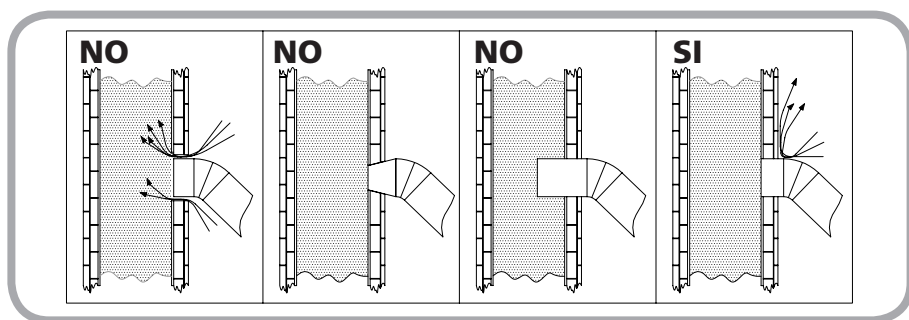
Esempi di corretto e scorretto allacciamento alla canna fumaria
